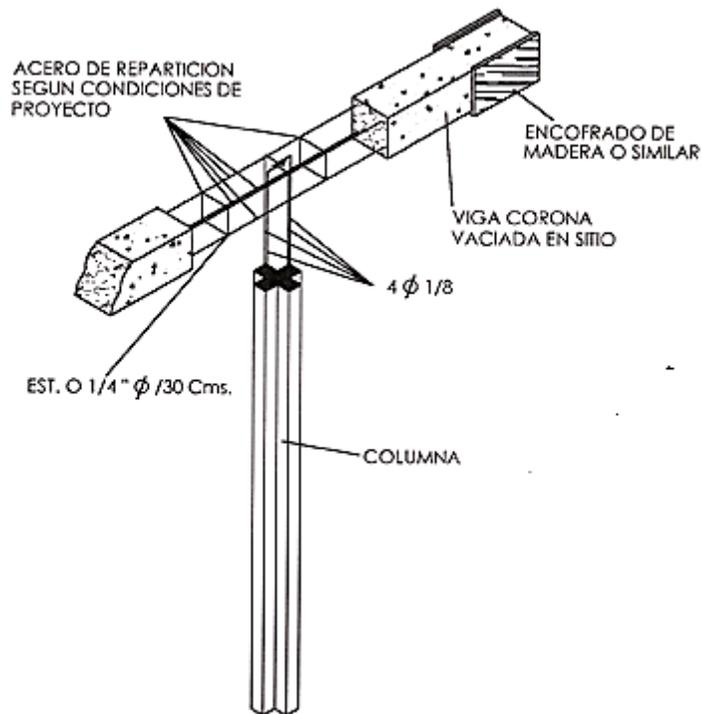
Detalle de Unión Tipo (Columna y Viga Corona)
